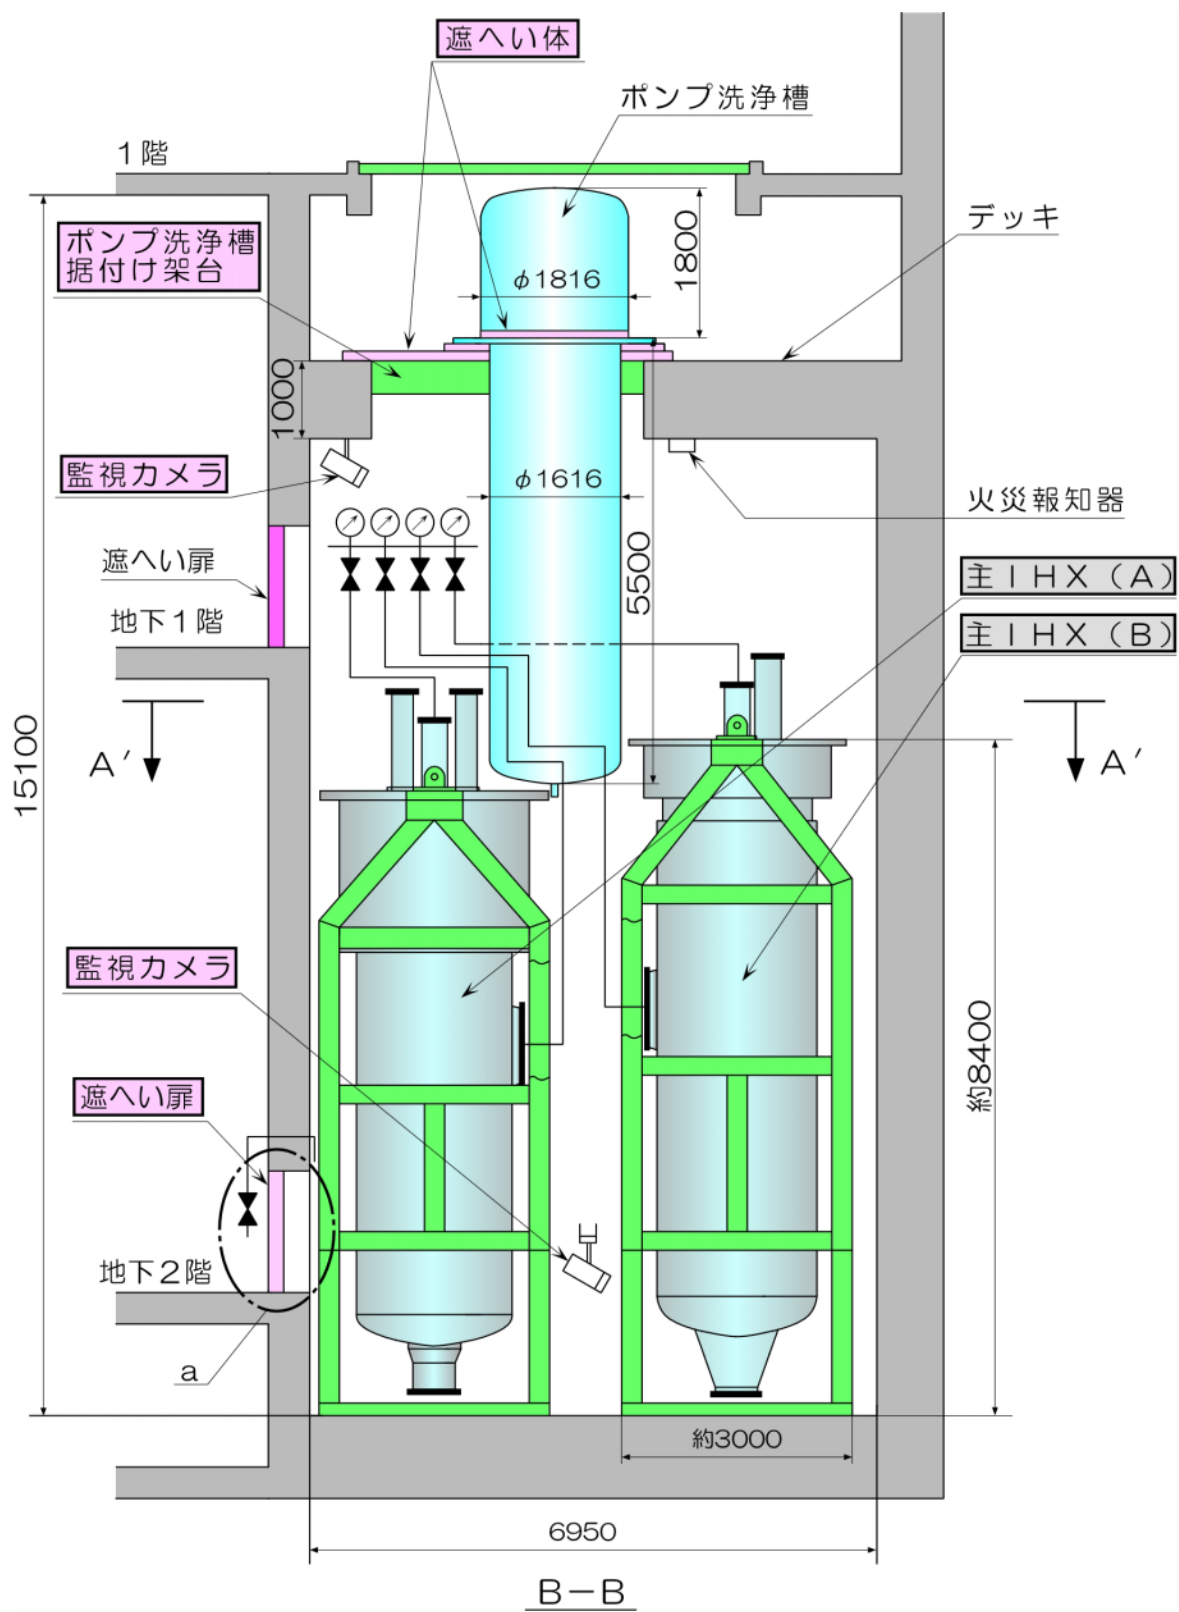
(1/3) 固体廃棄物貯蔵設備の構造図 (改造後) B-B 断面
